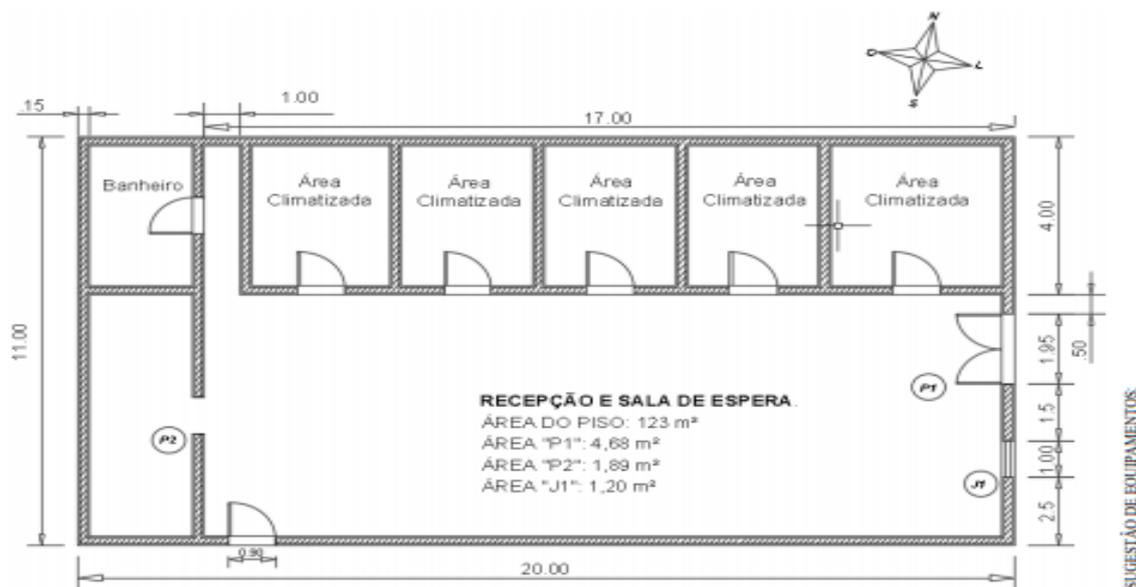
Planta Baixa, CAD. Fonte: Autor – 2018.
